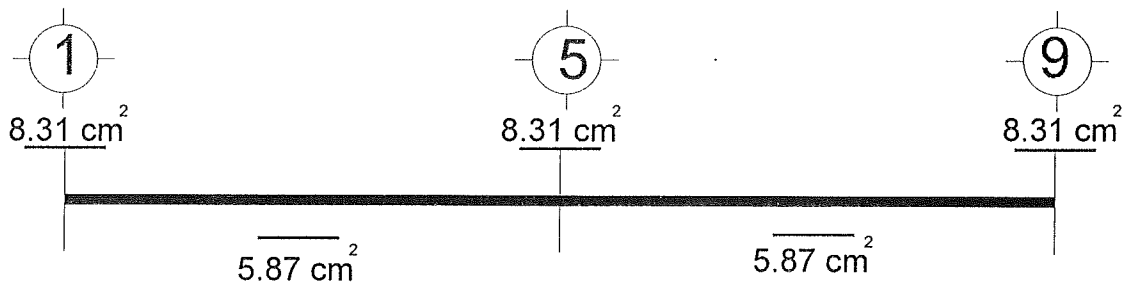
Áreas de acero de las traves de liga en la dirección Y.
